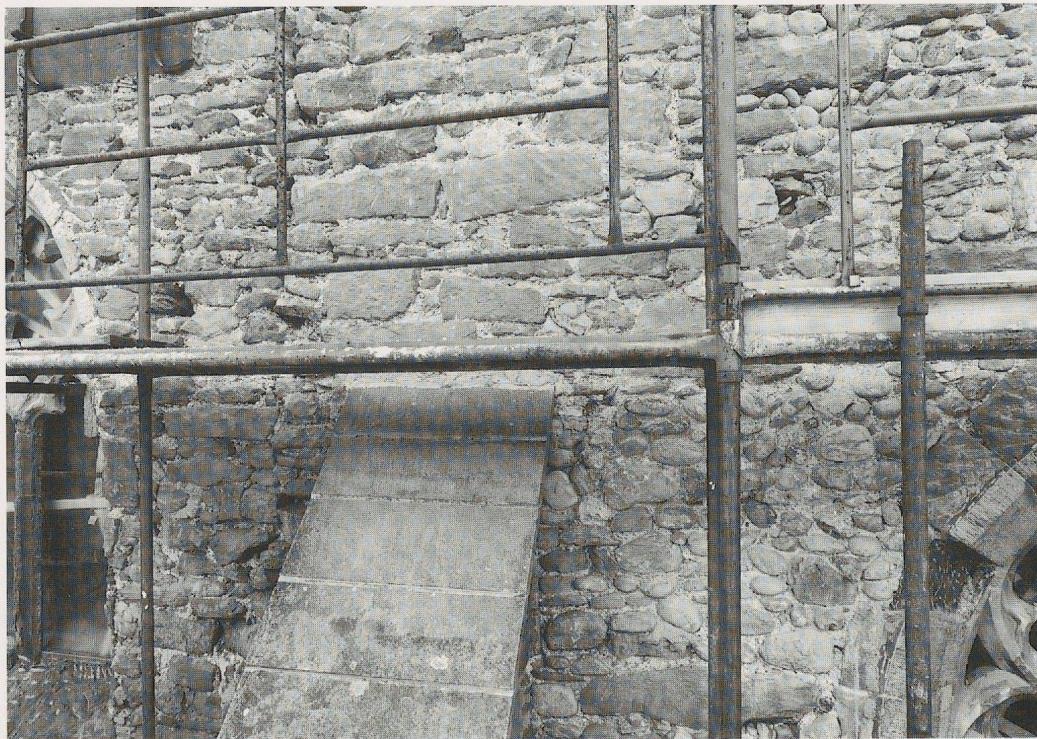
Façade sud de l'église; césure entre les structures de la nef et du chœur, à la hauteur du contrefort.
